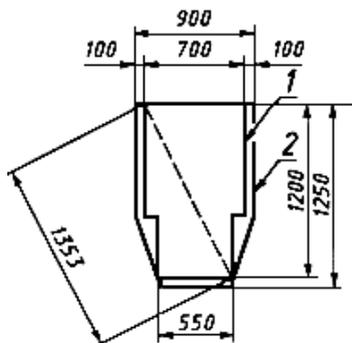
Размеры площадки для размещения инвалида в кресле-коляске в зоне размещения инвалидов: 1 — площадка для размещения кресла-коляски; 2 — площадка для размещения инвалида в кресле-коляске
